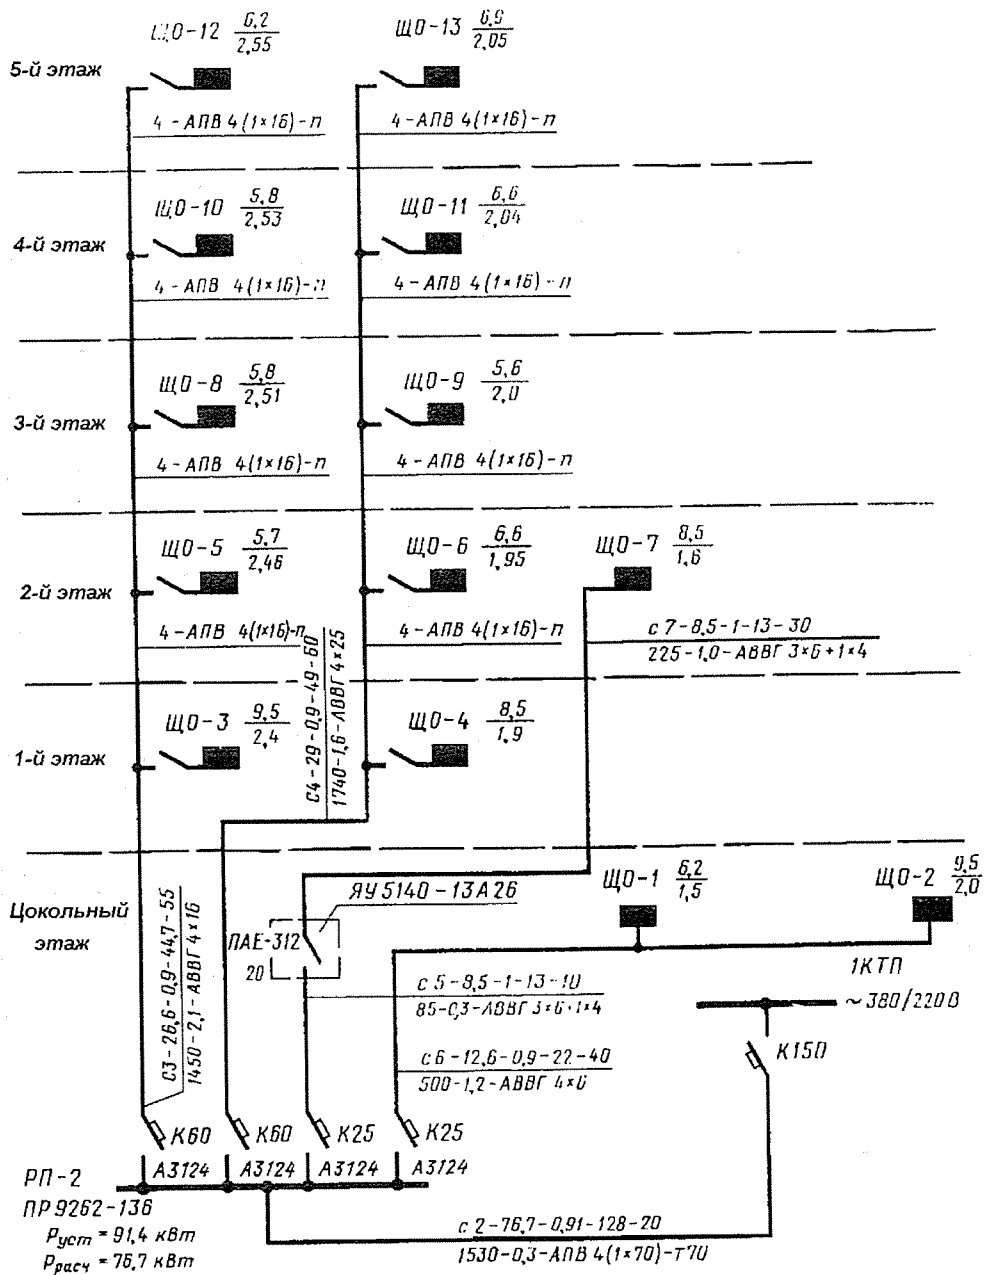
Пример оформления принципиальной схемы питающей сети многоэтажного здания
